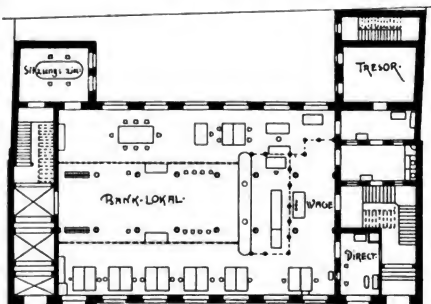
Grundriß der Reichsbank. Erdgeschoss.
